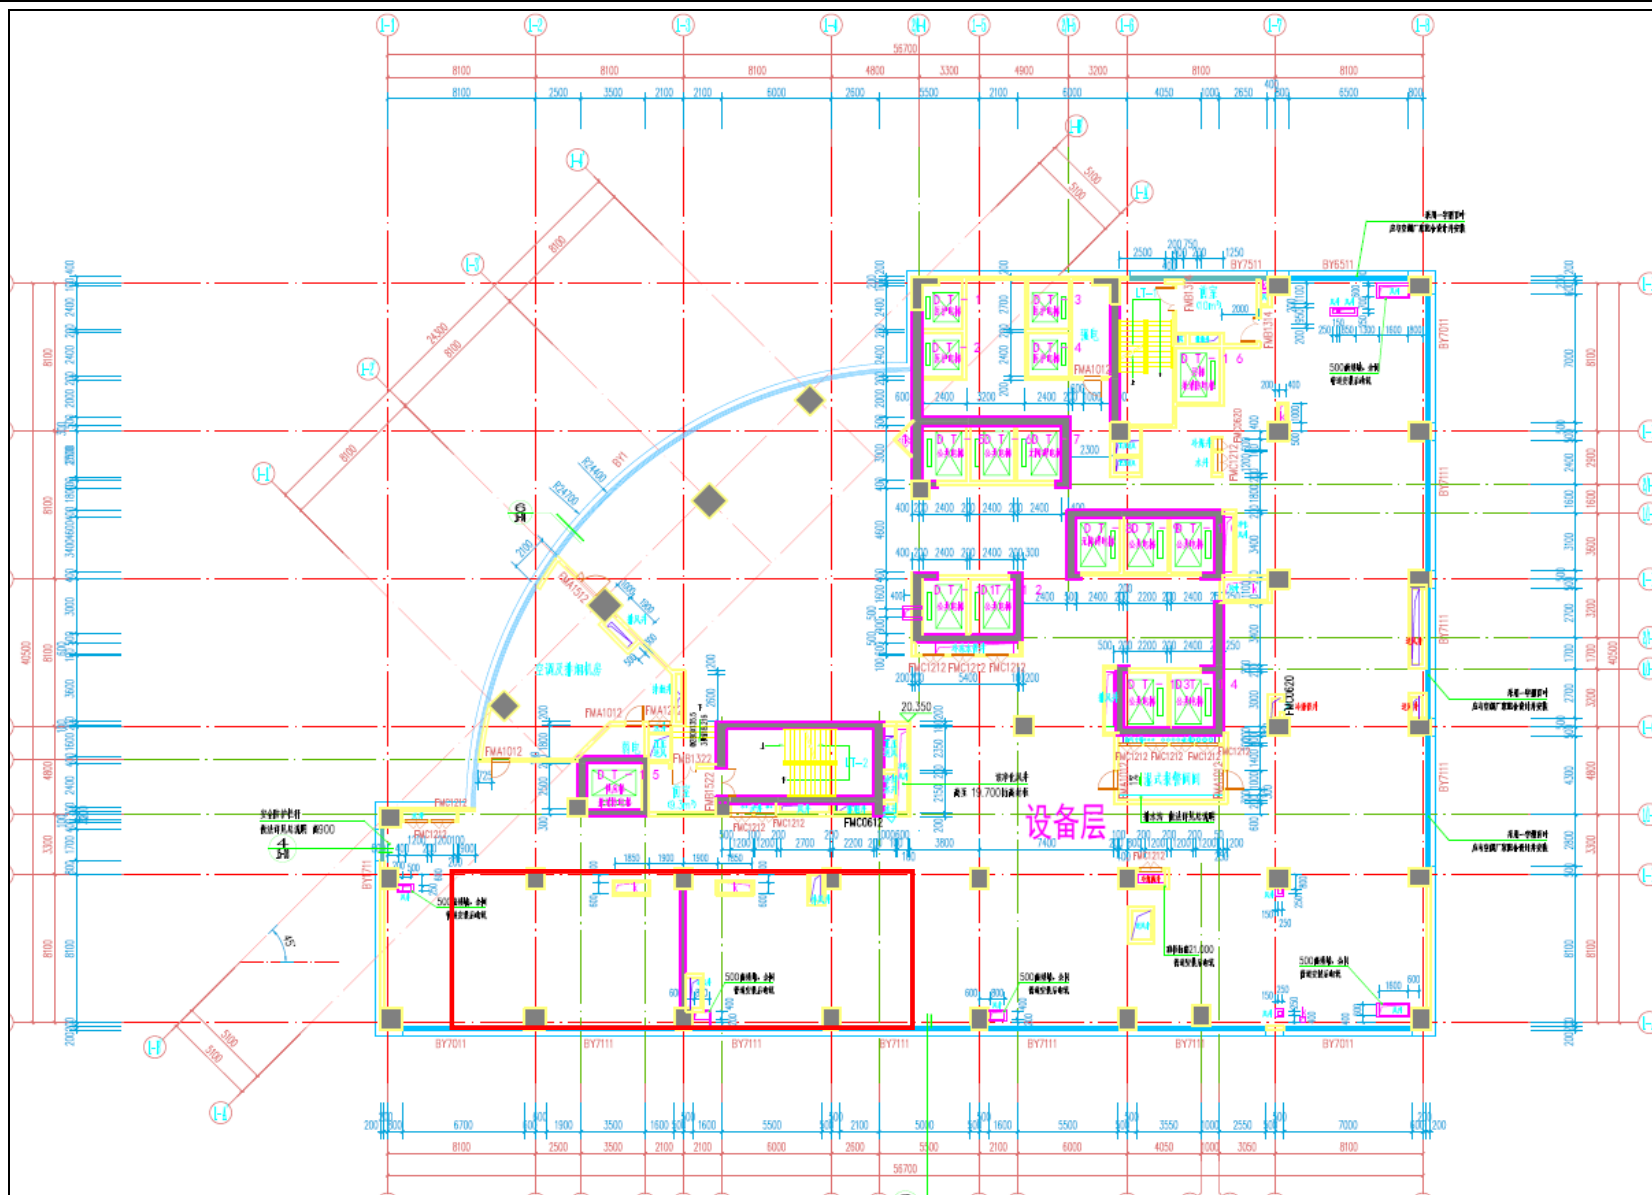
内科综合楼六层介入室楼下（投影）五层设备夹层平面布置图
